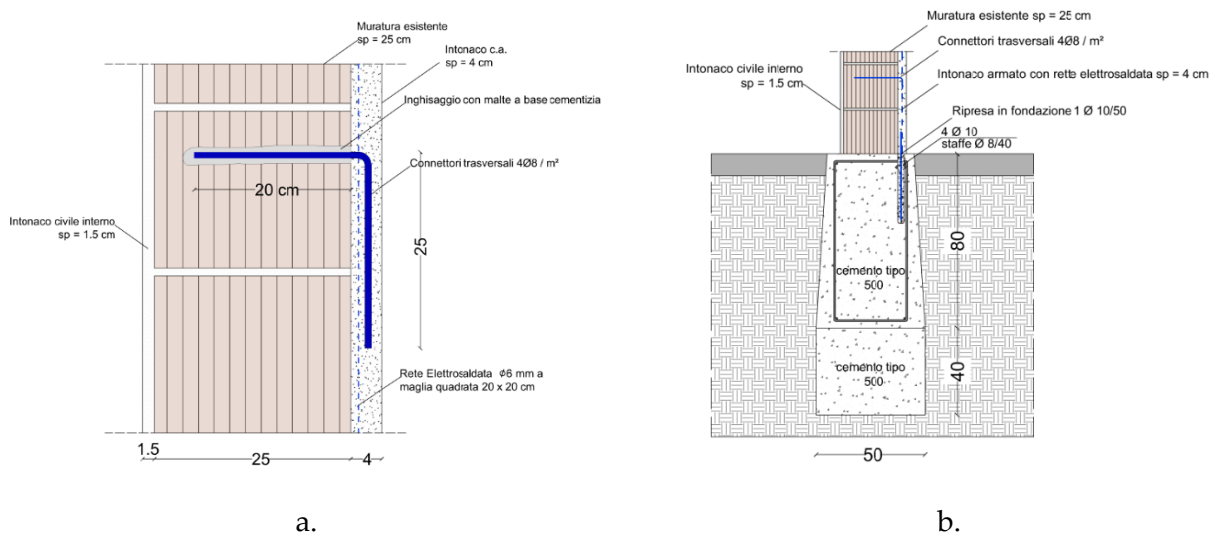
Dettagli costruttivi: a) connettore in acciaio; b) ancoraggio in fondazione.
